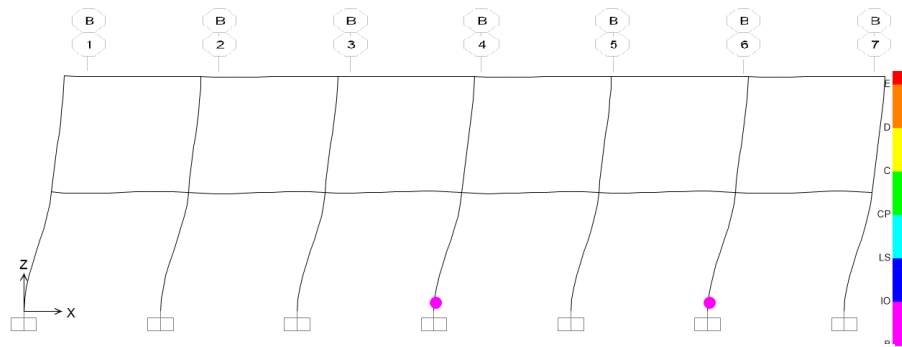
Deformada del pórtico B (frecuente). Fuente: Propia.
